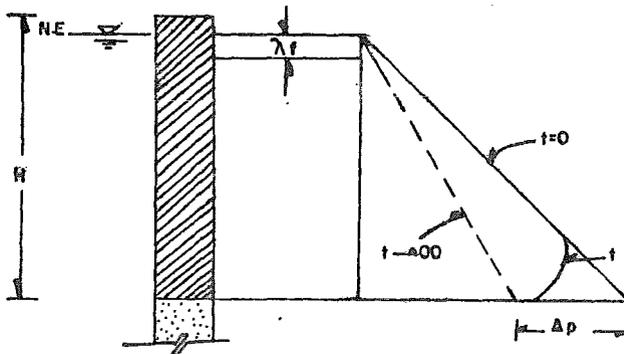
Manto de arcilla con estrato de arena en la base (Ref.23)
